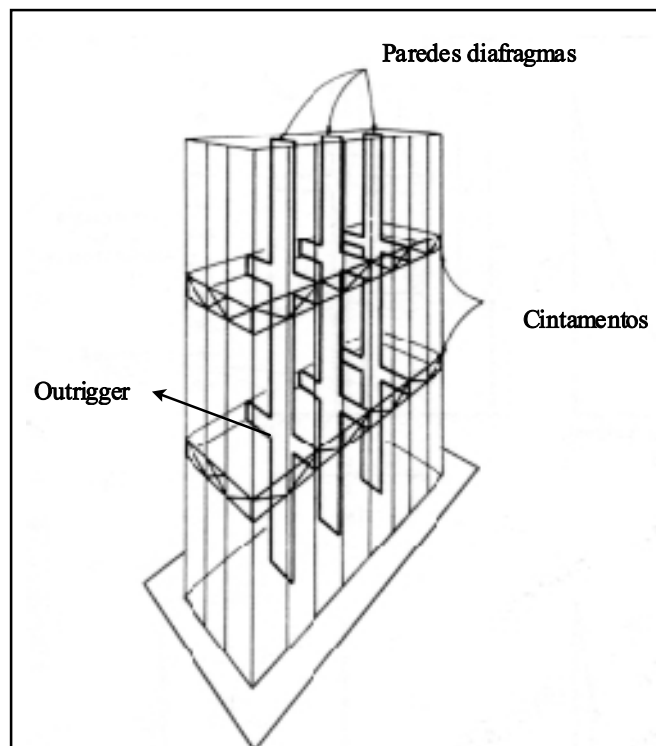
Sistema de contraventamento “outrigger” [ref. 36]
